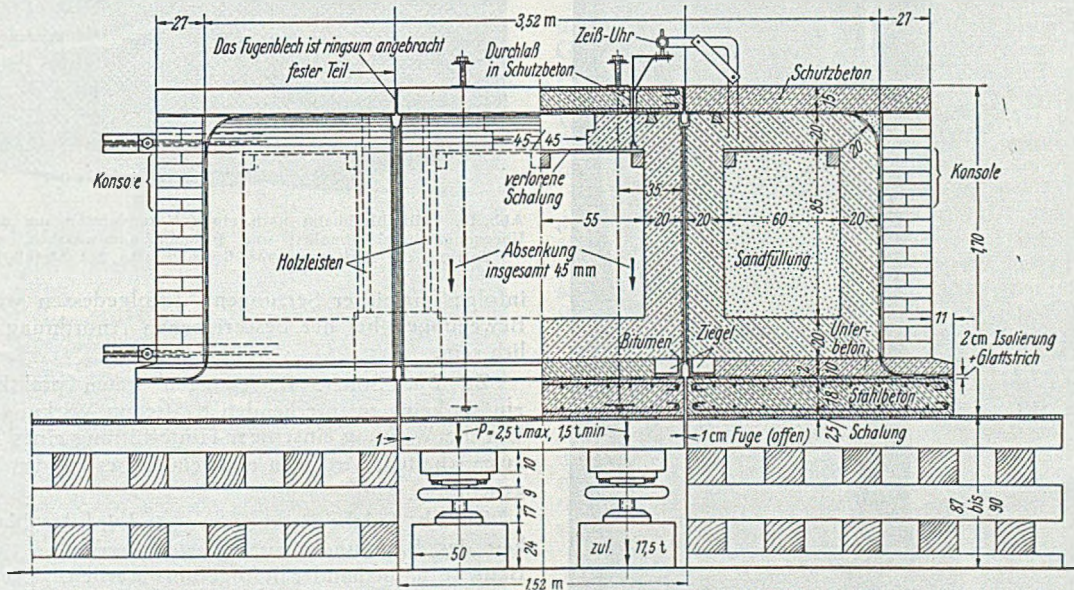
Aufbau des Großversuchs aus drei Betonklötzen mit Vorrichtung zum Verschieben.
